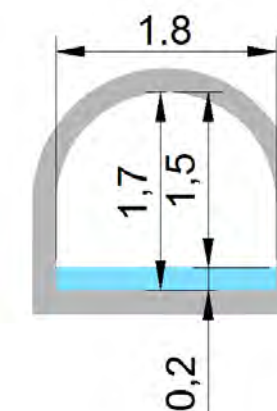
Profil en travers de l'ouvrage hydraulique de La Jambée (source : SEGIC)
